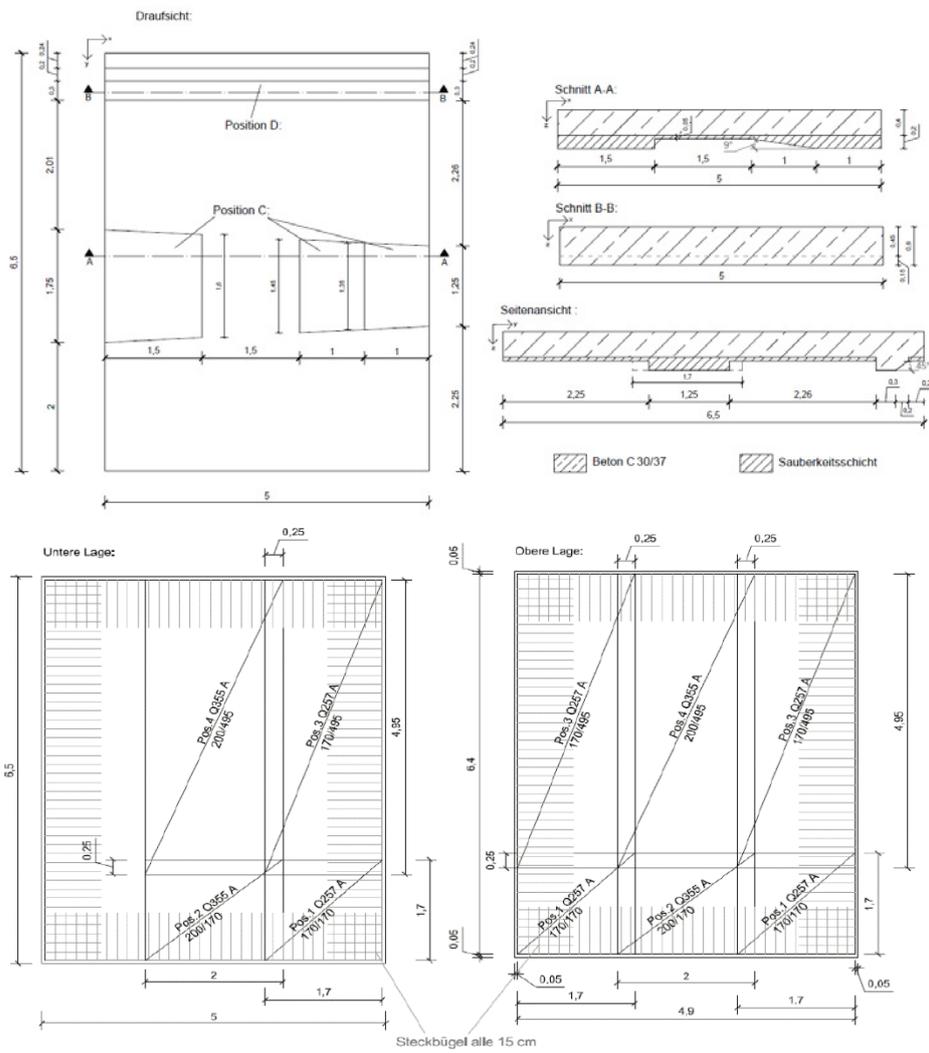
Betonmodell (oben) und Bewehrungsplan (unten)
